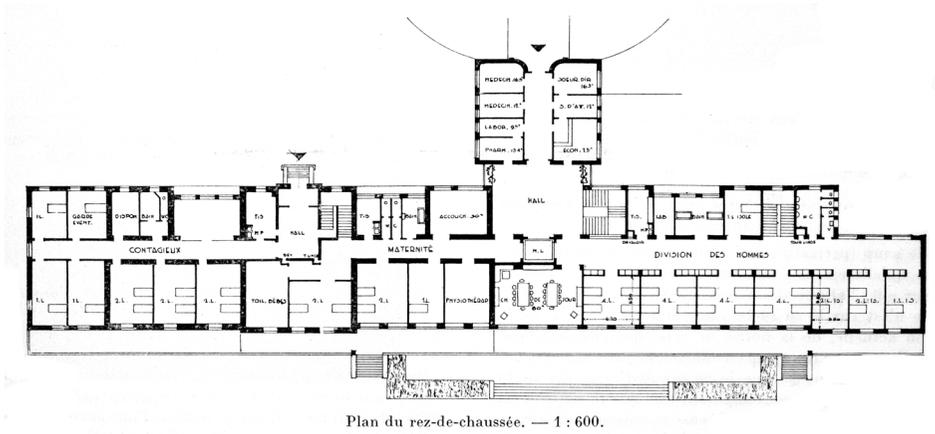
Yverdon, infirmerie, projet de concours d'Horace Decoppet, plan du rez-de-chaussée (tiré de: *BTSR*, 1936).
